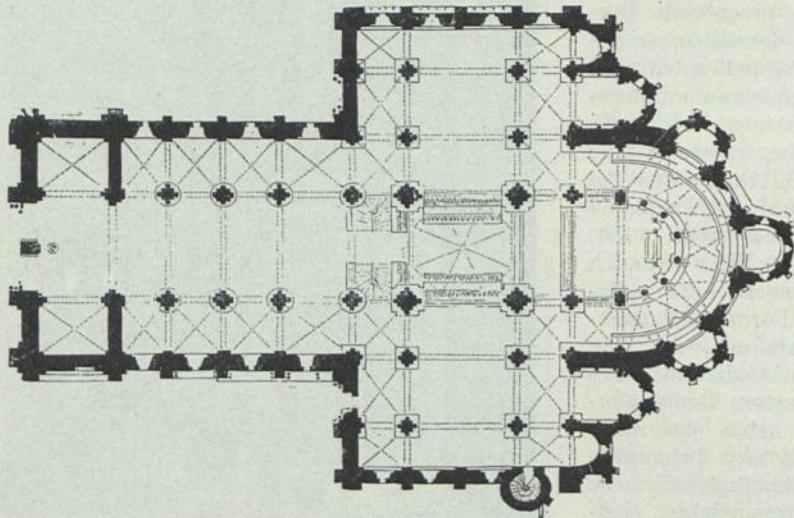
Grundriss der Abteikirche zu Conques
